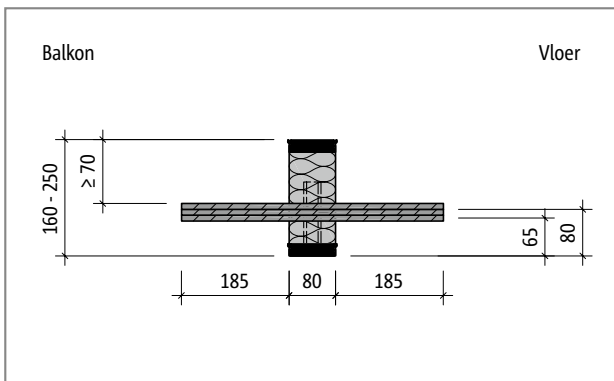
Schöck Isokorb® T type H-NN1: Bovenaanzicht
